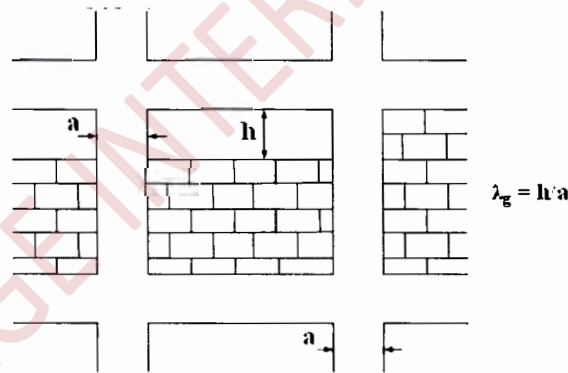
Cas de constitution de poteau court, par hauteur insuffisante de la maçonnerie de remplissage
